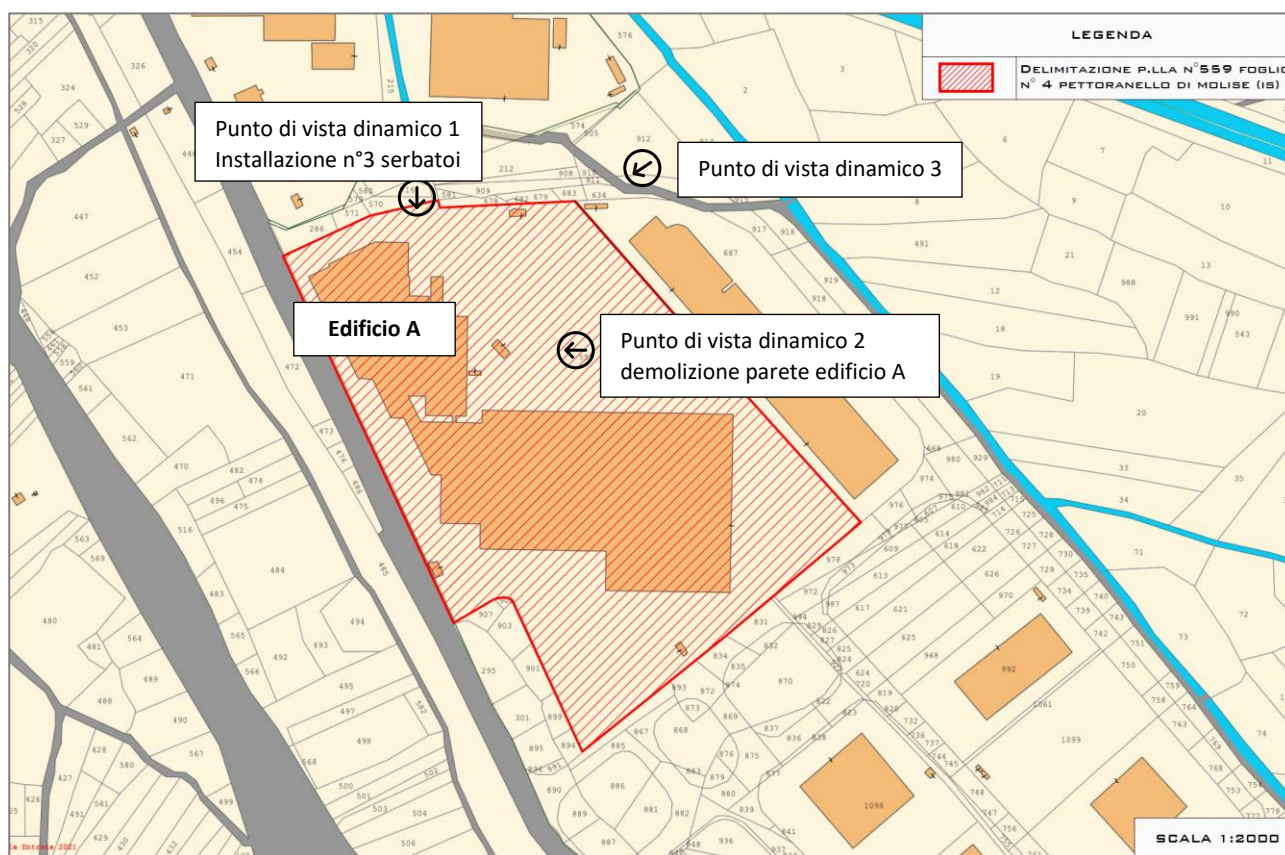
PLANIMETRIA FOTOGRAFICA SU BASE CATASTALE CON LOCALIZZAZIONE RIPRESE FOTOGRAFICHE.
